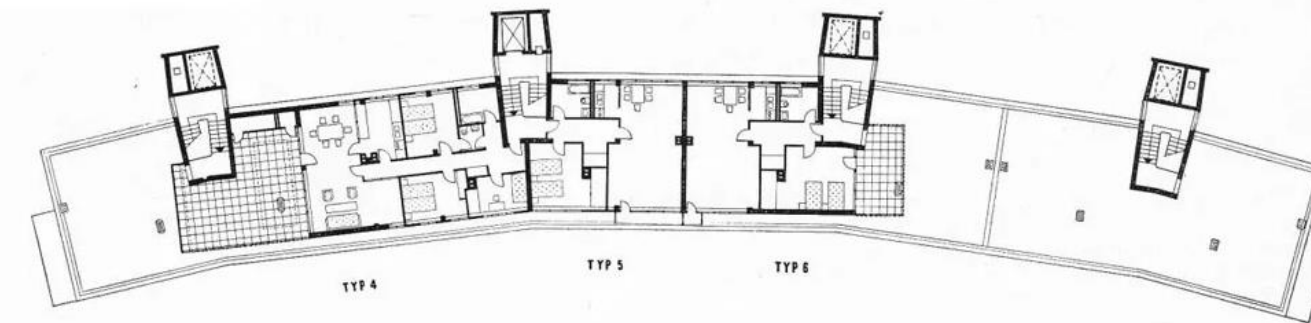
Bloque de viviendas en la Interbau, Planta Arquitectónica tipo. Gropius 1956
